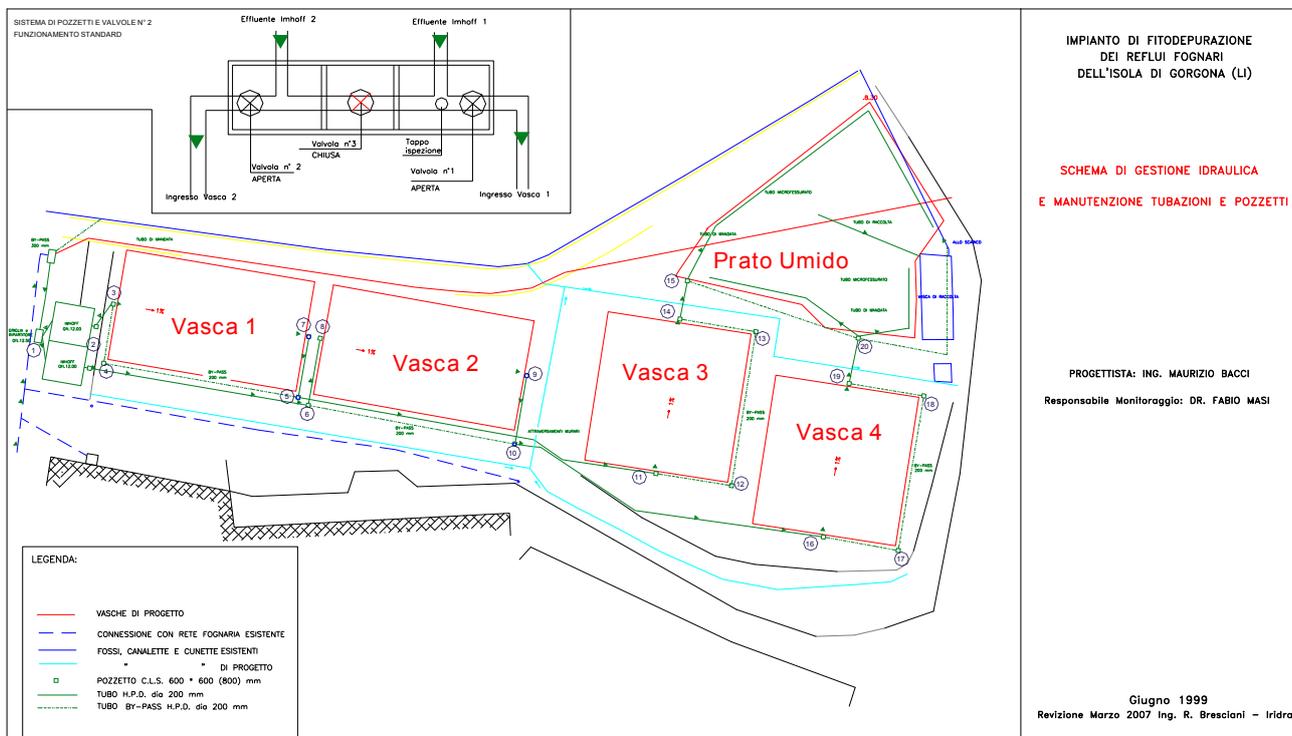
Planimetria impianto di fitodepurazione dell'isola di Gorgona – Progetto originale
